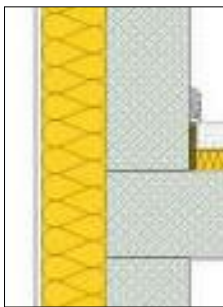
Secció vertical de façana de formigó armat amb revestiment exterior.
